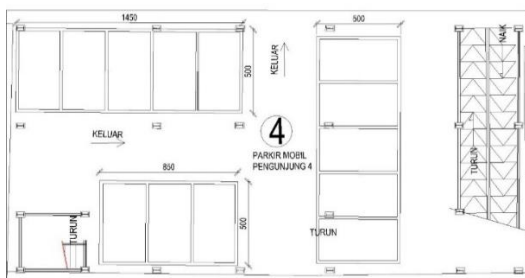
Lahan Parkir Mobil Pengunjung Depan
